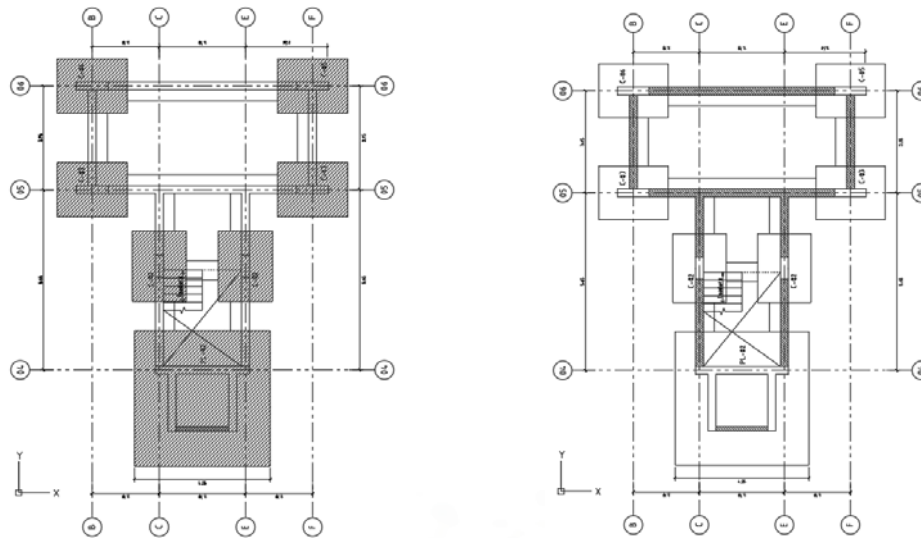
Losa maciza en zona de contracción de la planta entre los ejes 5-6.
